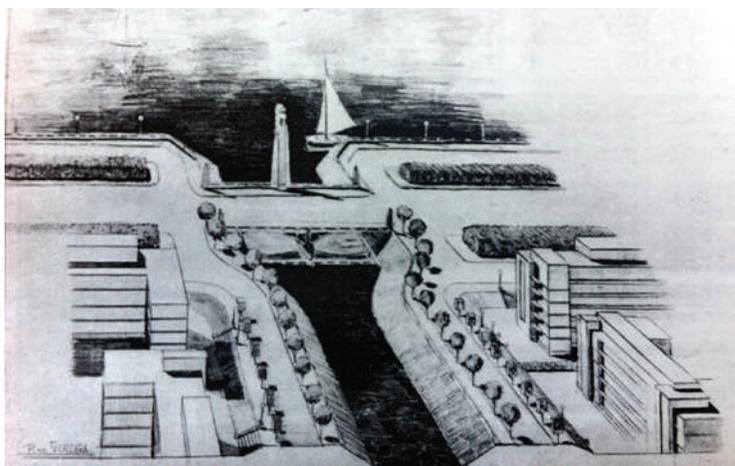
Ponte da Avenida Beira-Rio. Vista geral com a embocadura do canal. (SILVA 1943, 49)
